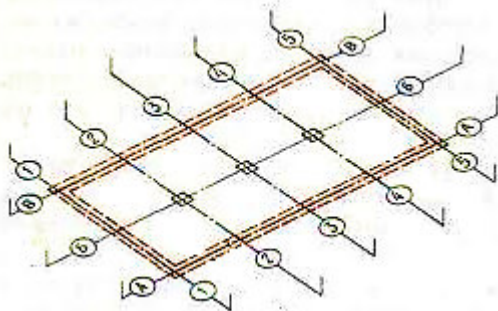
Схема закріплення осей будівлі або споруди на місцевості
